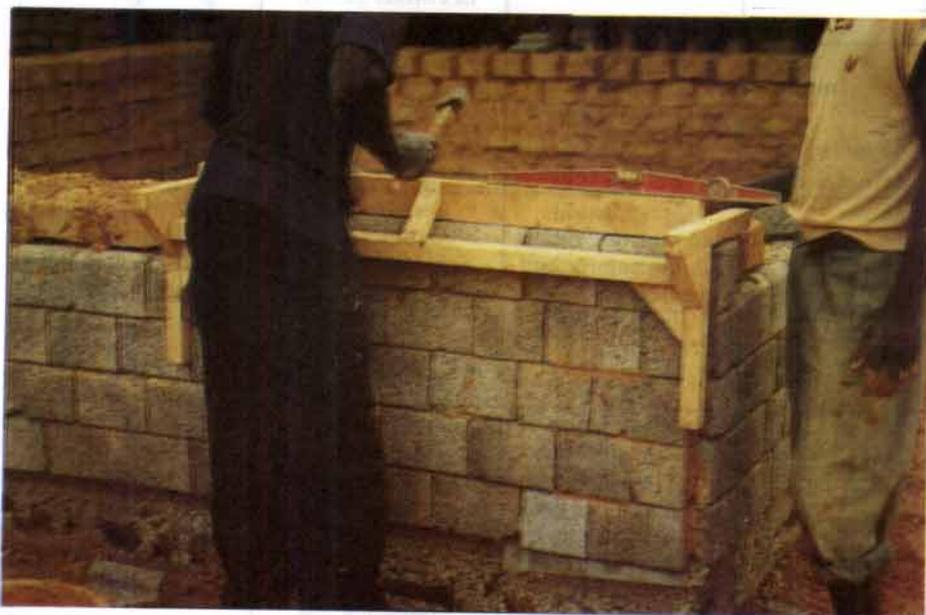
Mise en oeuvre de l'adobéton avec le gabarit de calage des écailles. Pour bien l'utiliser, il faut un marteau, un niveau et un maçon convenablement formé!
